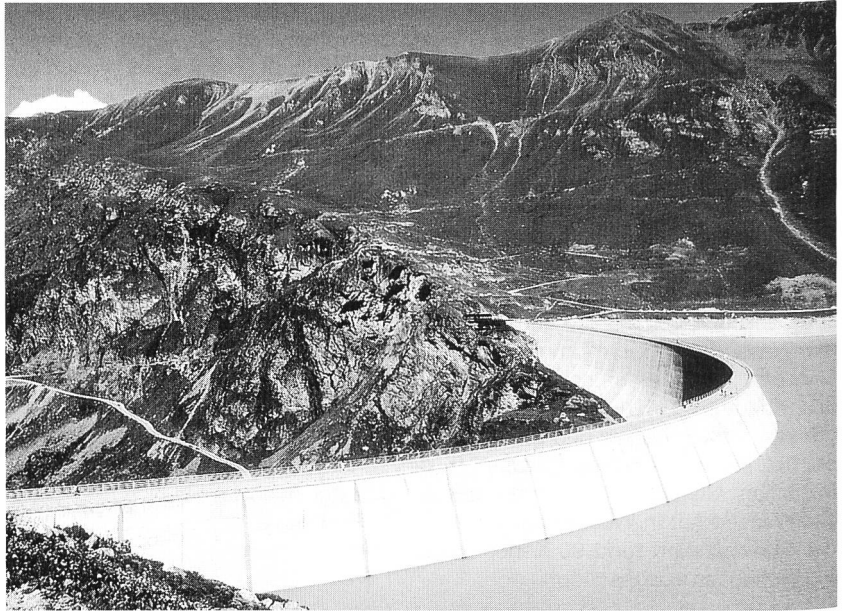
rechts. Bogenstaumauer Moiry im Kanton Wallis (Höhe 148 m, Fertigstellung 1958) (Foto B. F. Gardel, EPFL).
